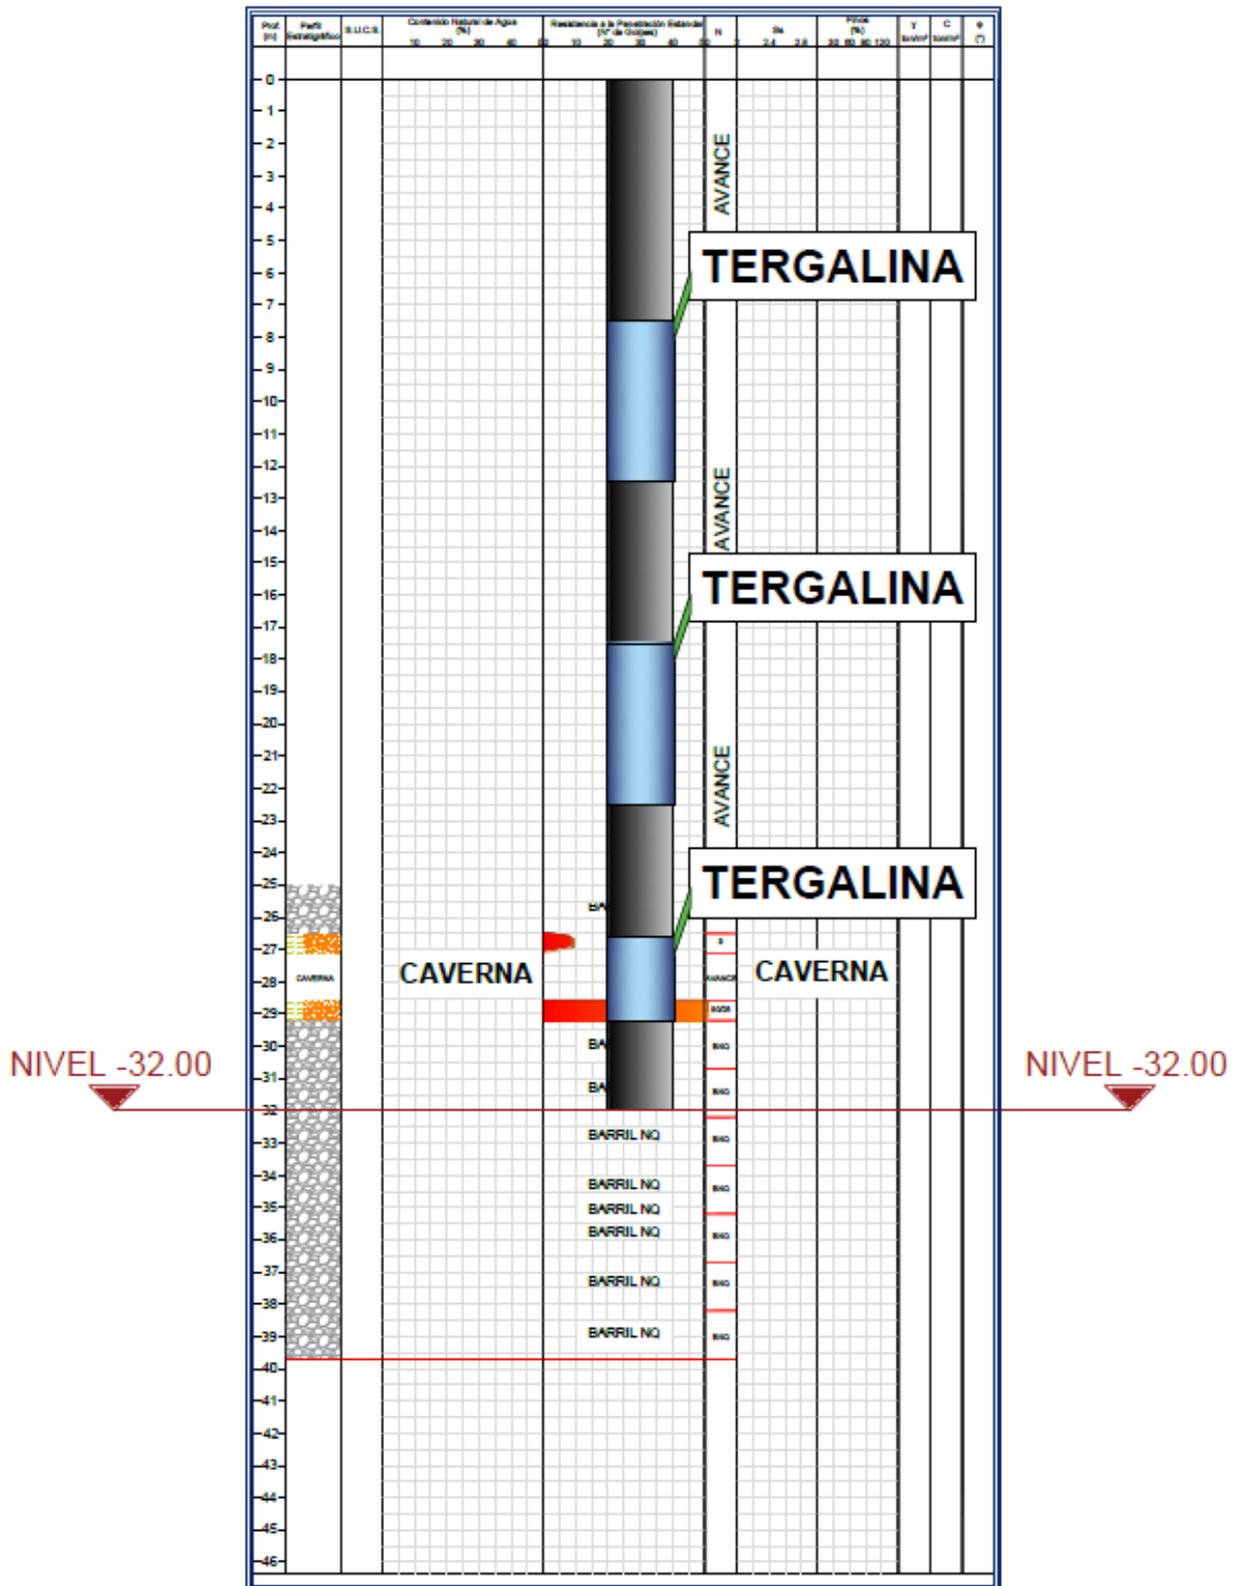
PILA 8 (SM-8 EJE F3).
